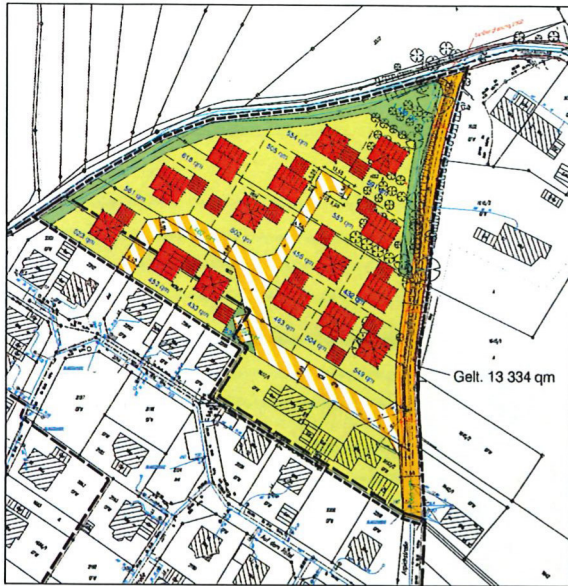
Alternative des städtebaulichen Entwurfs mit Verschwenkung Straße
